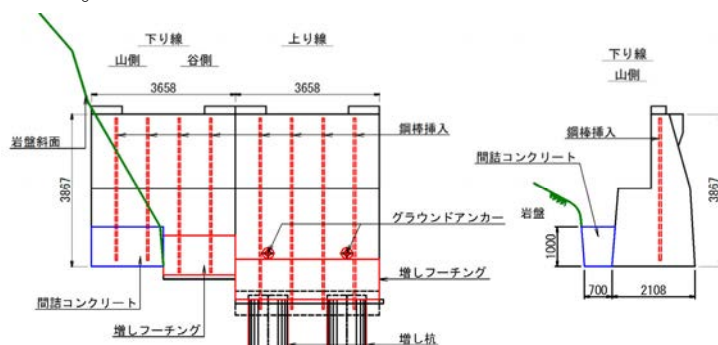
耐震補強図 (A2 橋台正面図, 側面図)
